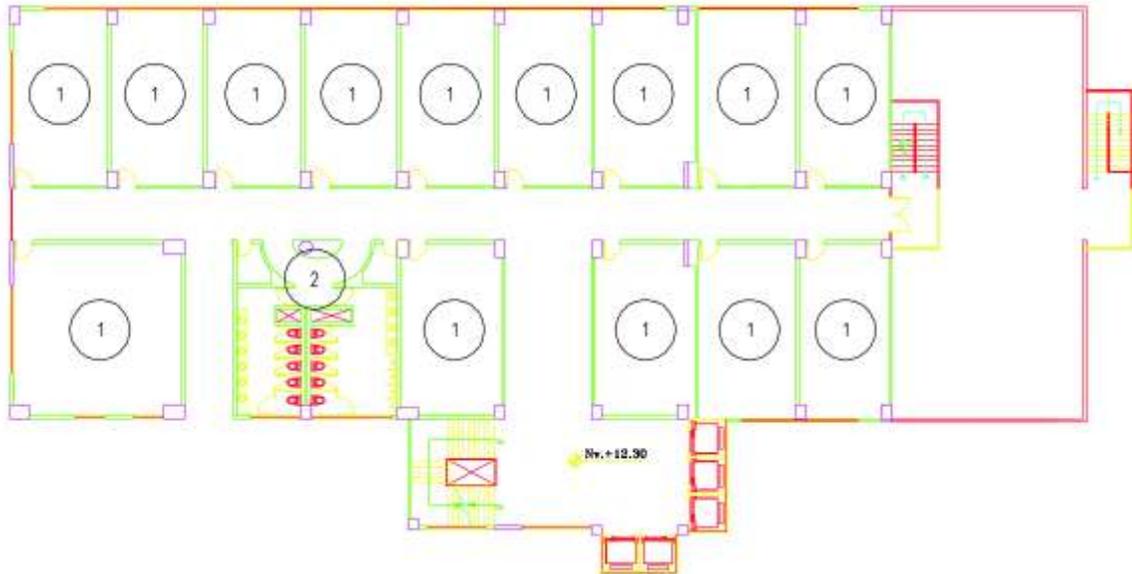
Distribución EARME primera etapa, Planta tercer piso
